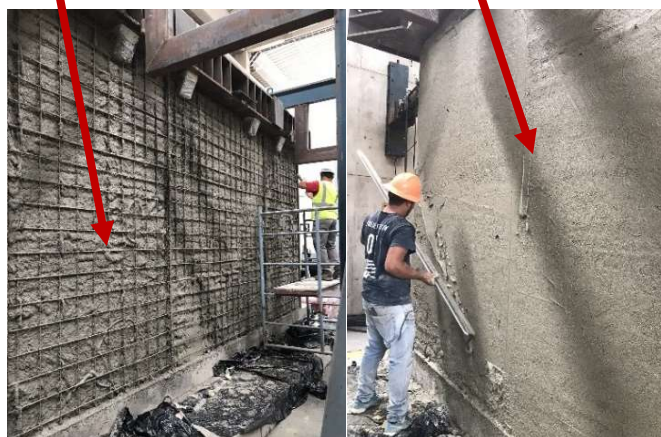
Lanzado de segunda capa de mortero (25 mm).
